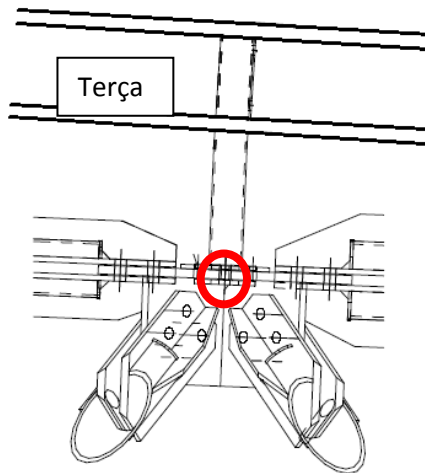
Localização do ponto visado para levantamento da cobertura translúcida.
